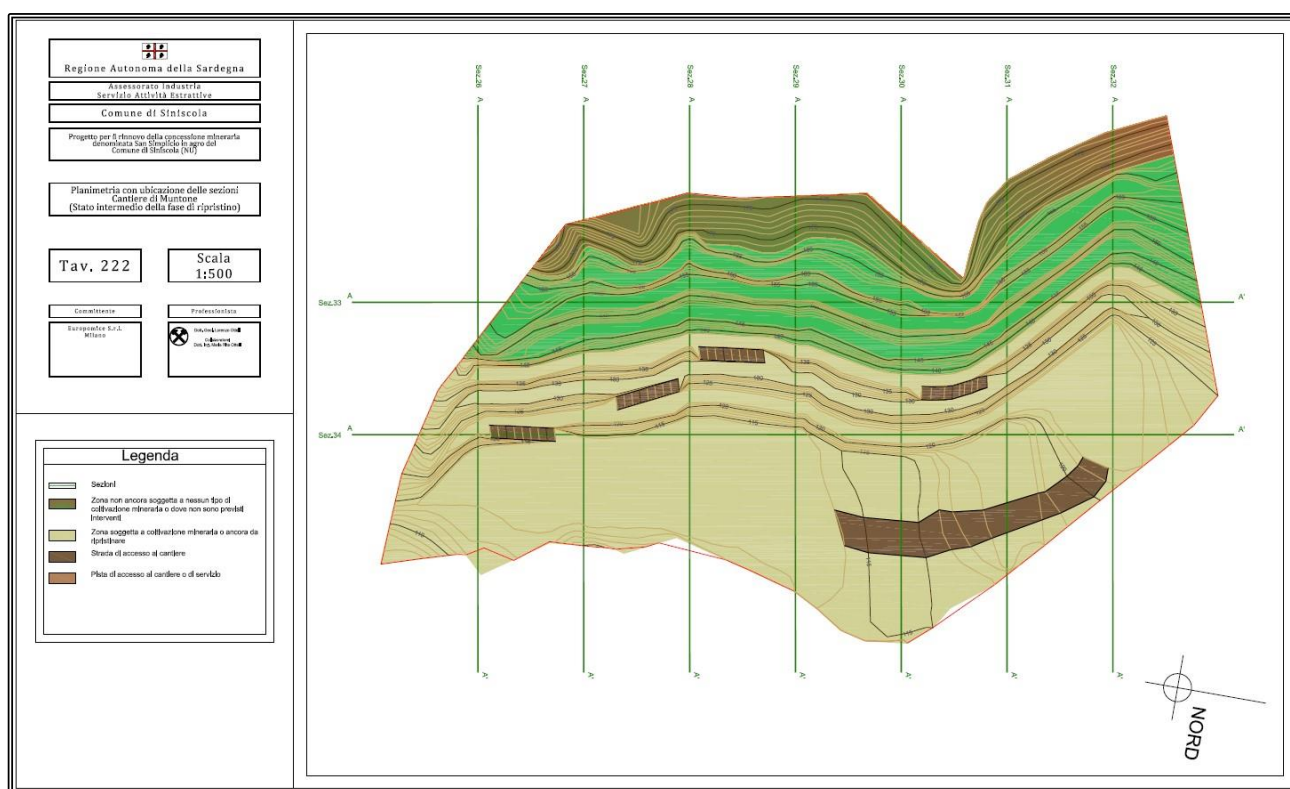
Planimetria dell'area del cantiere di Muntone così come nello stato intermedio del ripristino.
